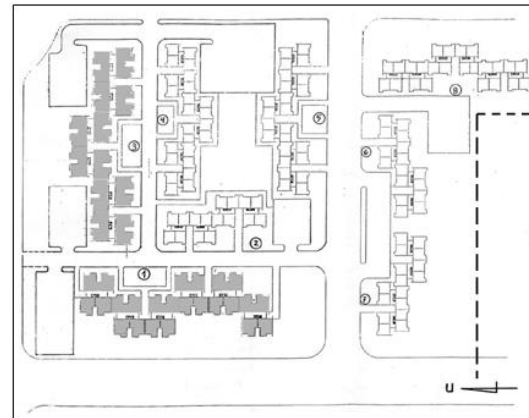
Blok Plan Rumah Susun Kemayoran [5]
